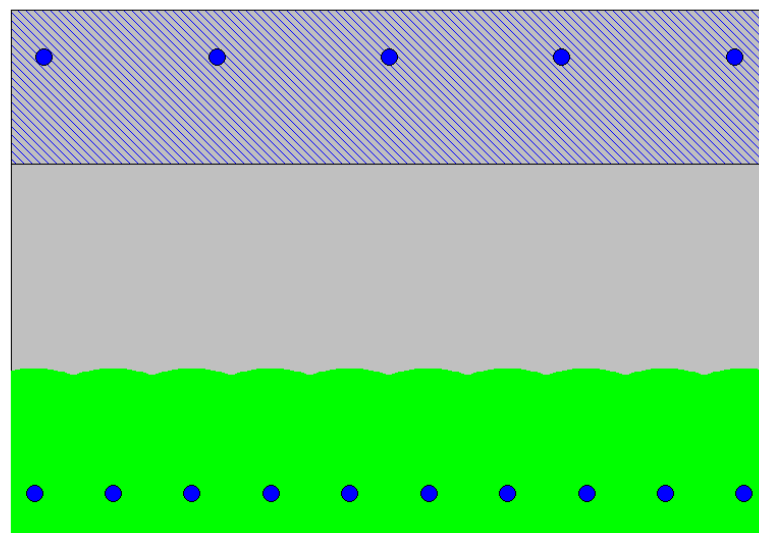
Sezione strutturale 1 – Verifica Fessurazione
